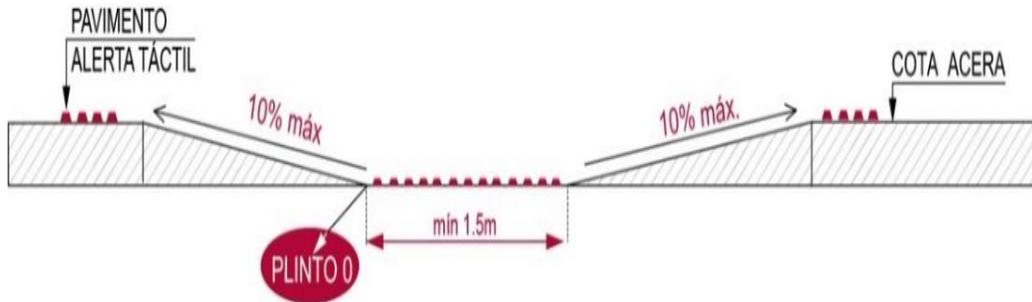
Cruce peatonal rebajado en una vereda de ancho a 1.20 metros, la vereda baja en todo su ancho hasta alcanzar la cola de la calzada.
